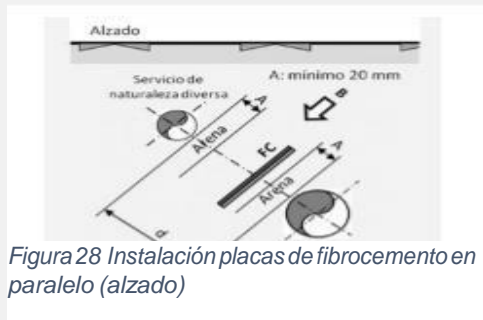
Instalación placas de fibrocemento en paralelo (alzado)
